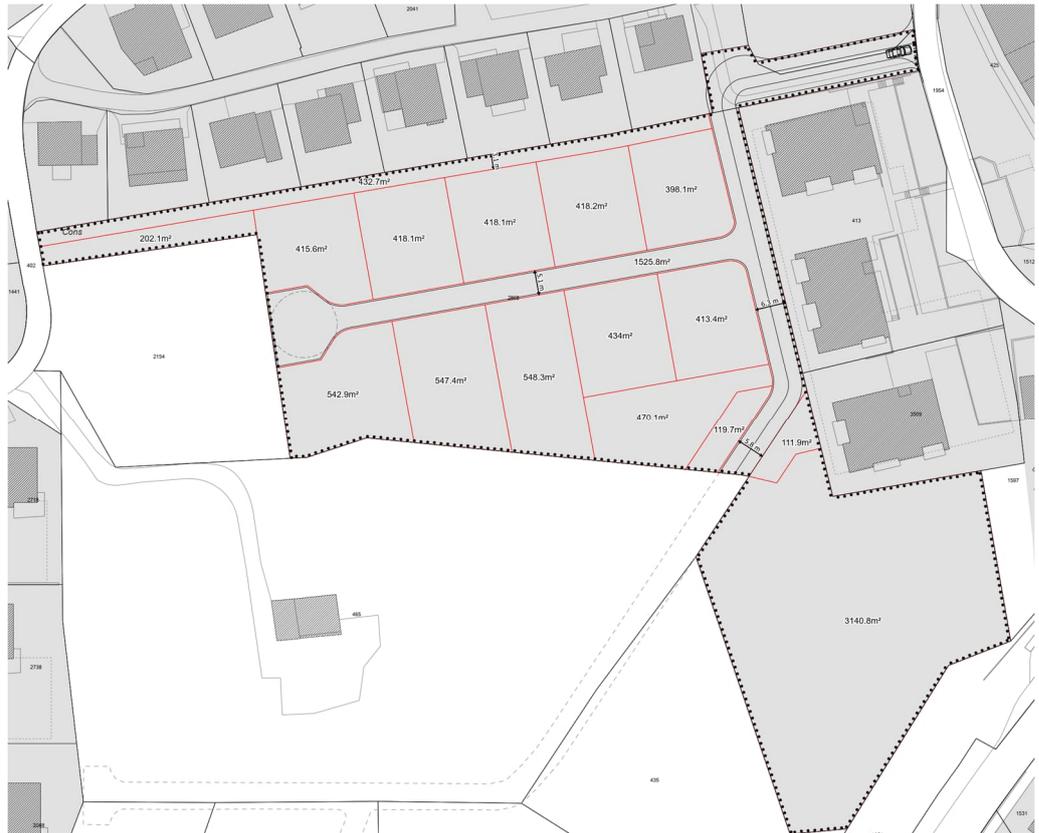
Ausschnitt Plan Neuzuteilung (massstabslos)
